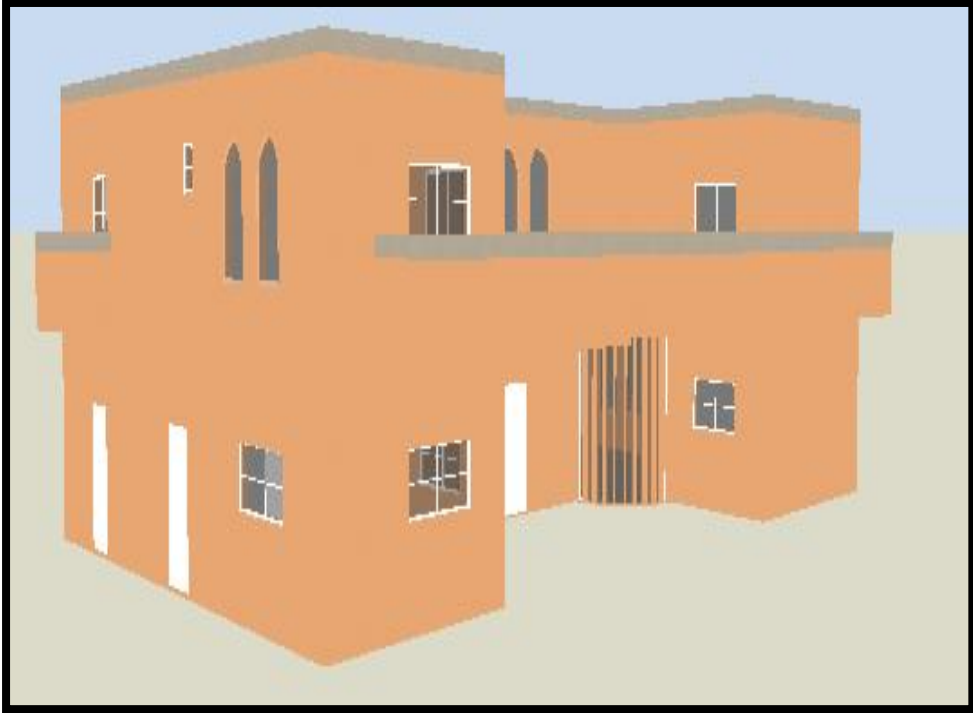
صورة مخطط يبين المسقط الرأسي للمبنى في البرنامج
